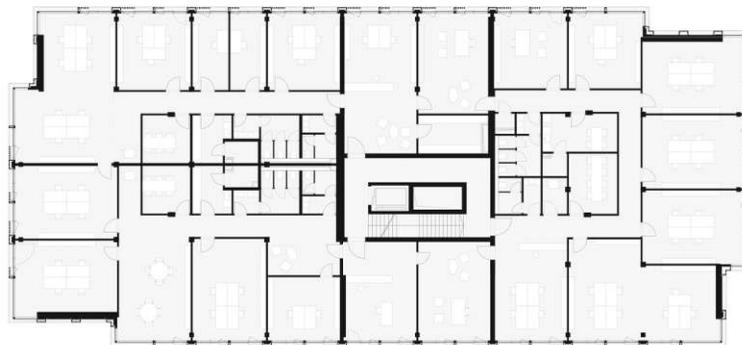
Das bestehende Tragwerk ermöglicht flexible Büroteilungen.
